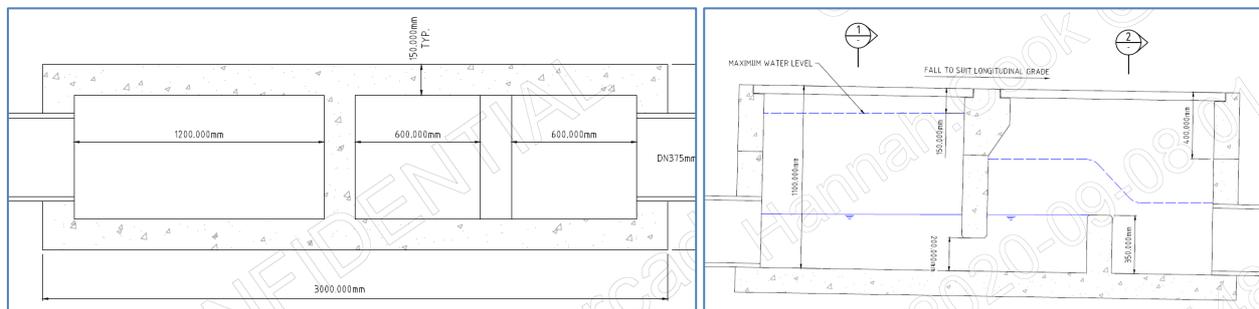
Vista superiore e sezione longitudinale di un pozzetto tagliafiamma tipico
